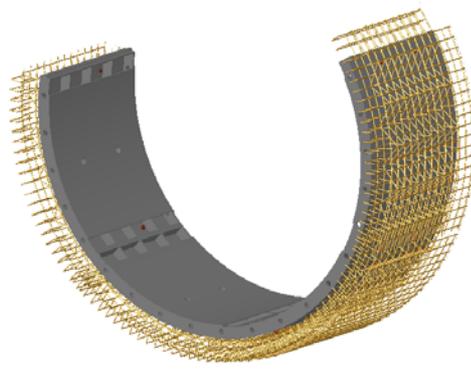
Schalenelement, mit Befestigung, Abstandshalter und Bewehrungskorb
